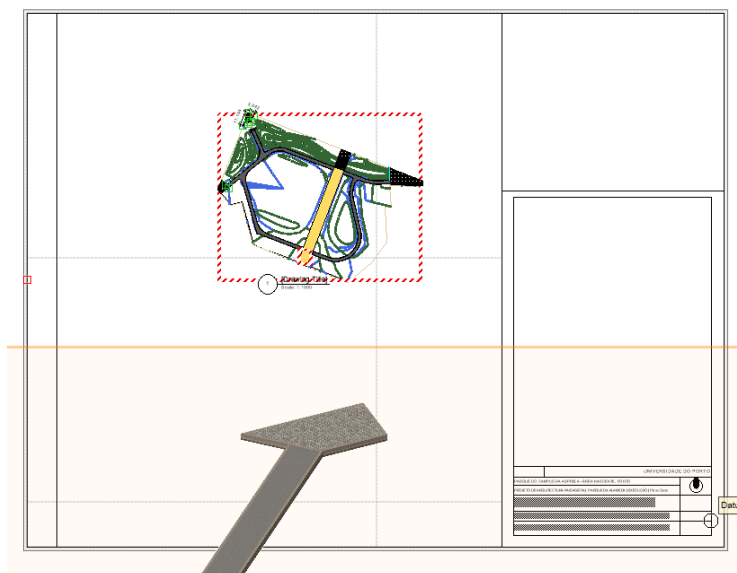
Peça técnica - Plano com pormenor construção em 3D
